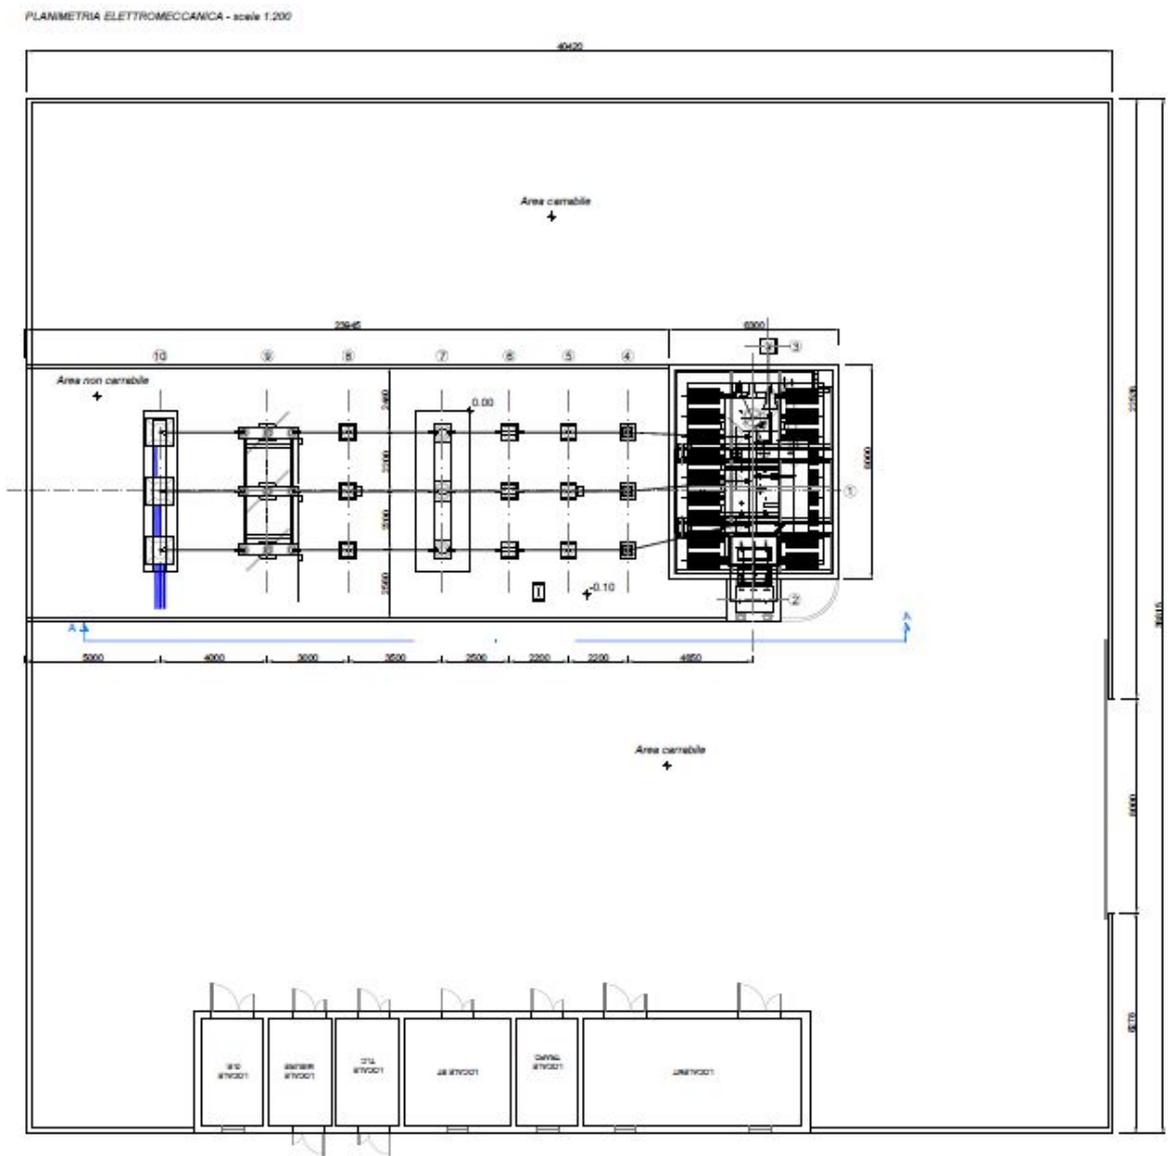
Planimetria elettromeccanica di progetto della SSE utente di Ariano Irpino
